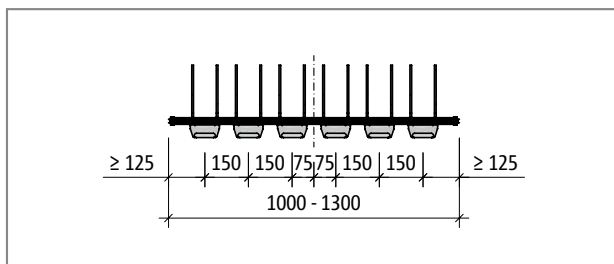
Schöck Tronsole® Typ T-V6-H...-L1000 bis L1300: Produktgrundriss
